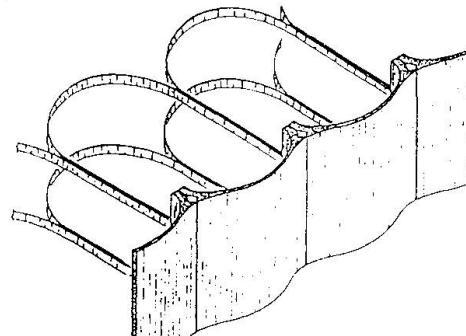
STRUCTURE: BÉTON/ÉTRIERS
